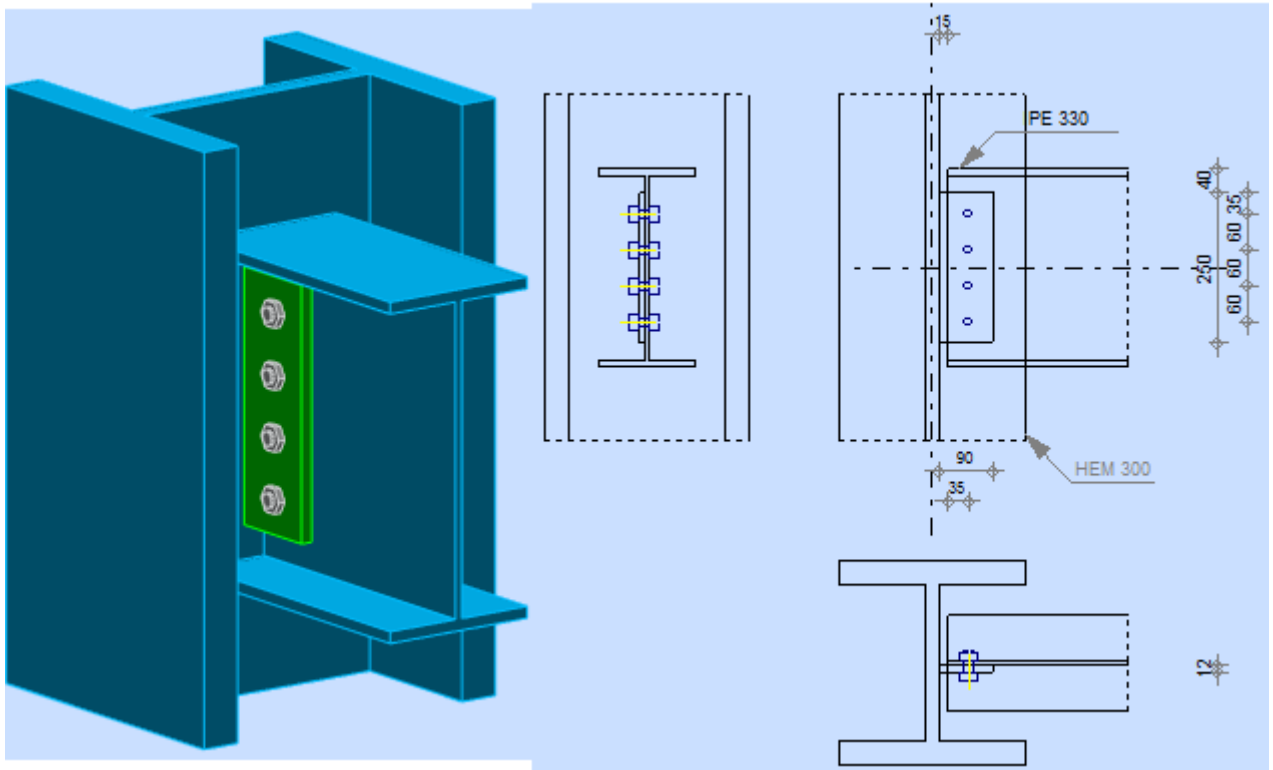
Représentation de l'assemblage poteau HEM 300 – poutre IPE 330
